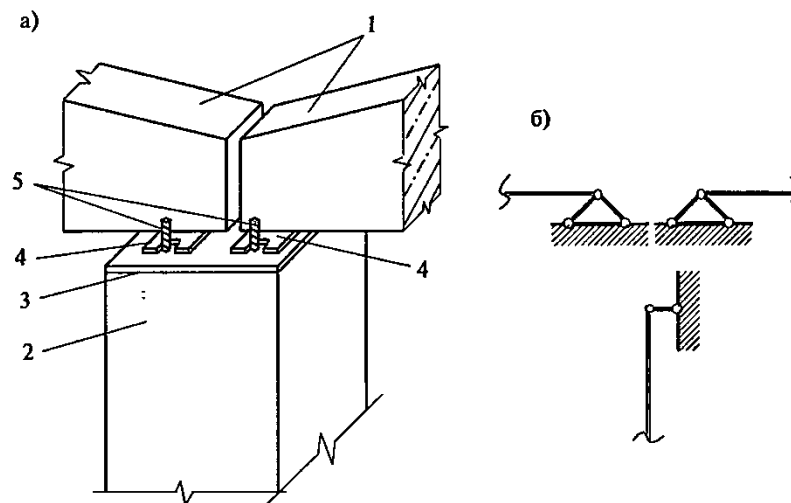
Шарнирное опирание стропильной железобетонной балки на колонну: а) схема опирания; б) расчетная схема опирания балок на колонну и колонны на балки; 1 — балки; 2 — колонна; 3 — опорная плита колонны; 4 — закладные детали балки; 5 — болты (гайки не показаны)
